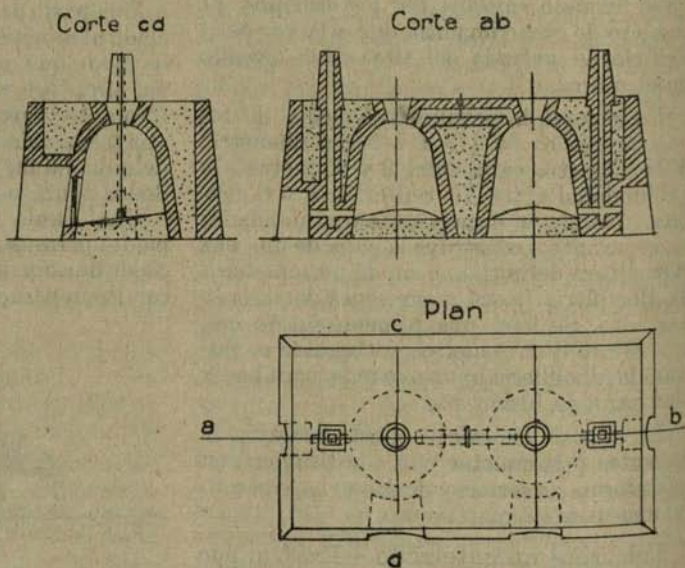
Horno Gill de dos cámaras. Cortes y Planta.
